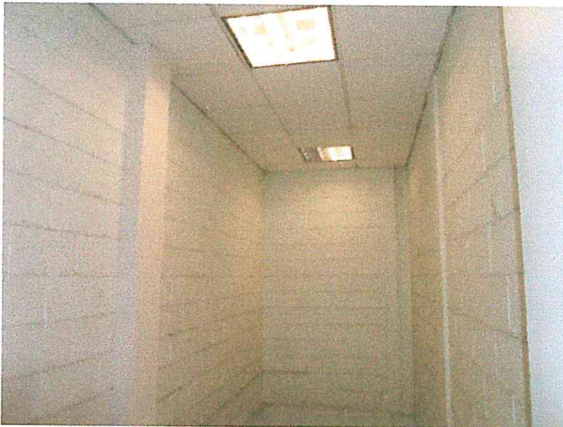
Muro de block, cadenas y castillos de concreto armado del cubo de la escalera, sin afectaciones estructurales.
